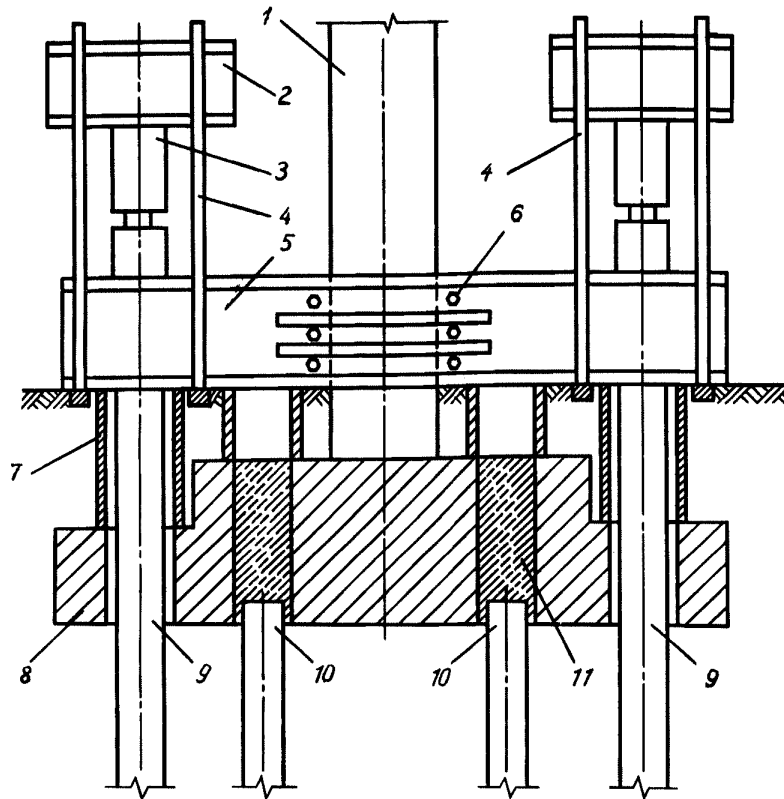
Усиление фундамента вдавливаемыми сваями при отсутствии возможности устройства пространства под подошвой фундамента
